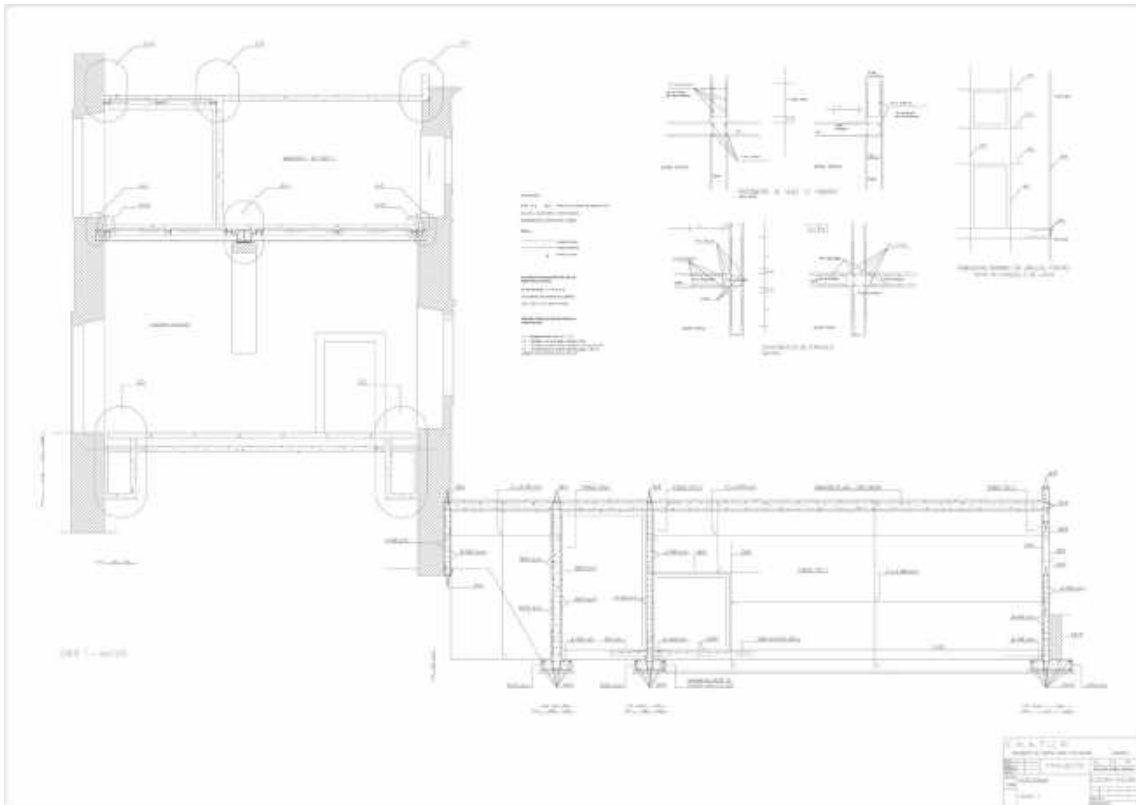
Sección constructiva que detalla la estructura de edificio antiguo y moderno.
